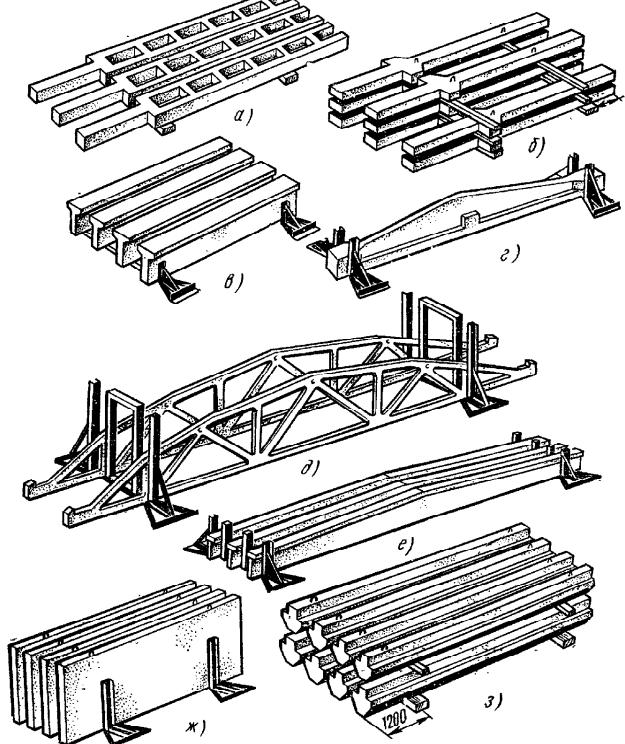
Складирование железобетонных конструкций промышленных зданий:
